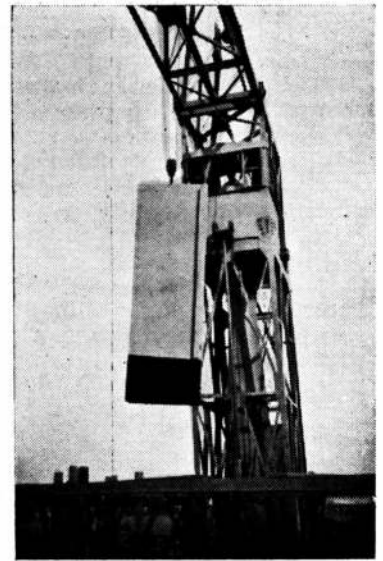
Esquina de una casa que se rellena mediante molde metálico juntamente con el encadenado.
